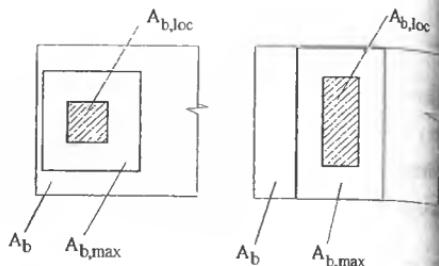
Схема расчета по прочности железобетонных элементов на местное сжатие
